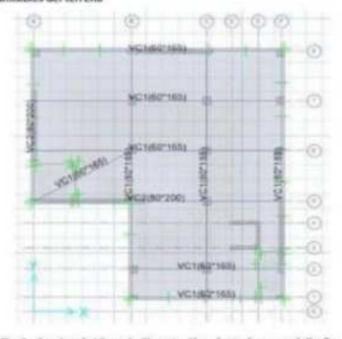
Seccion de Vigas de Cimentación adoptadas para el diseño.
